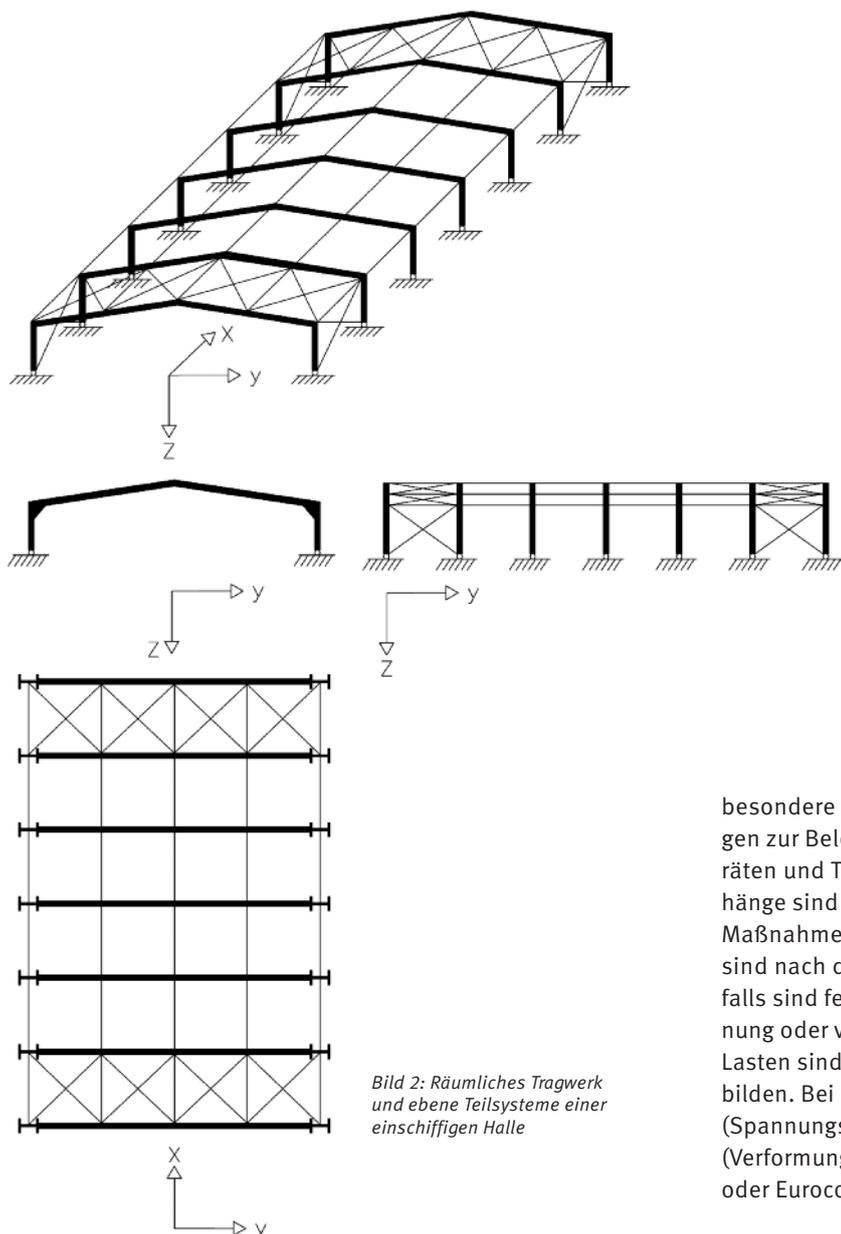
Räumliches Tragwerk und ebene Teilsysteme einer einschiffigen Halle
